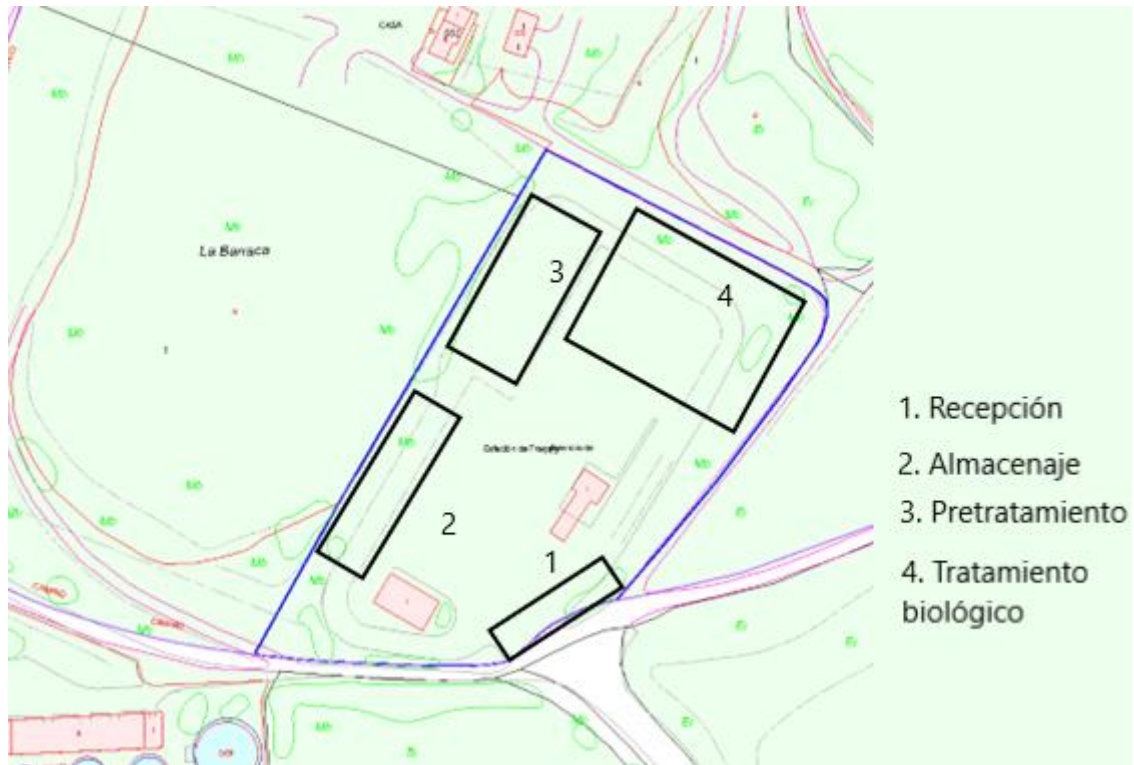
Croquis disposición planta de tratamiento. Fuente: Elaboración Propia.
